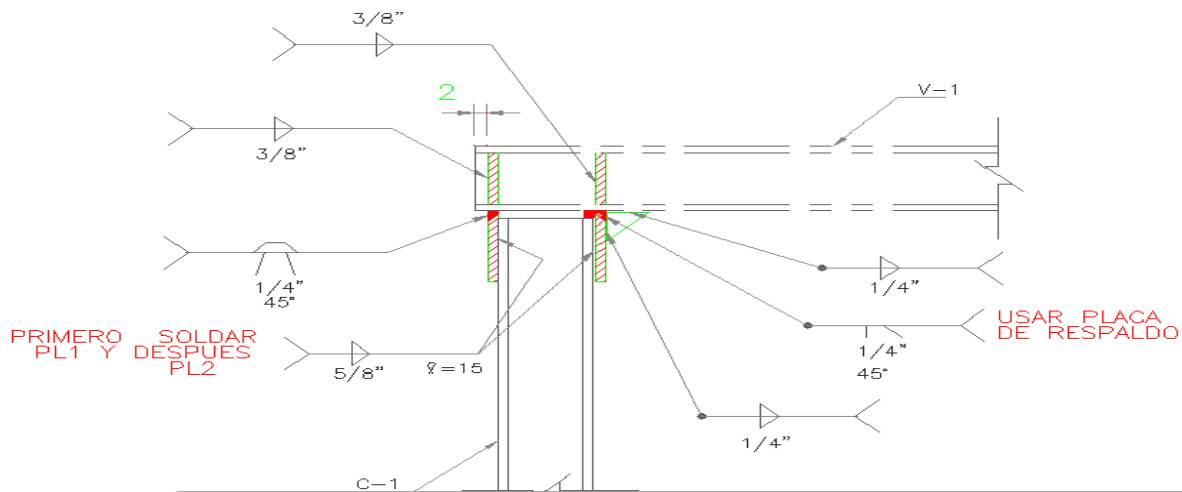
Conexión viga V-1 a columna C-1 (Soldadura)
